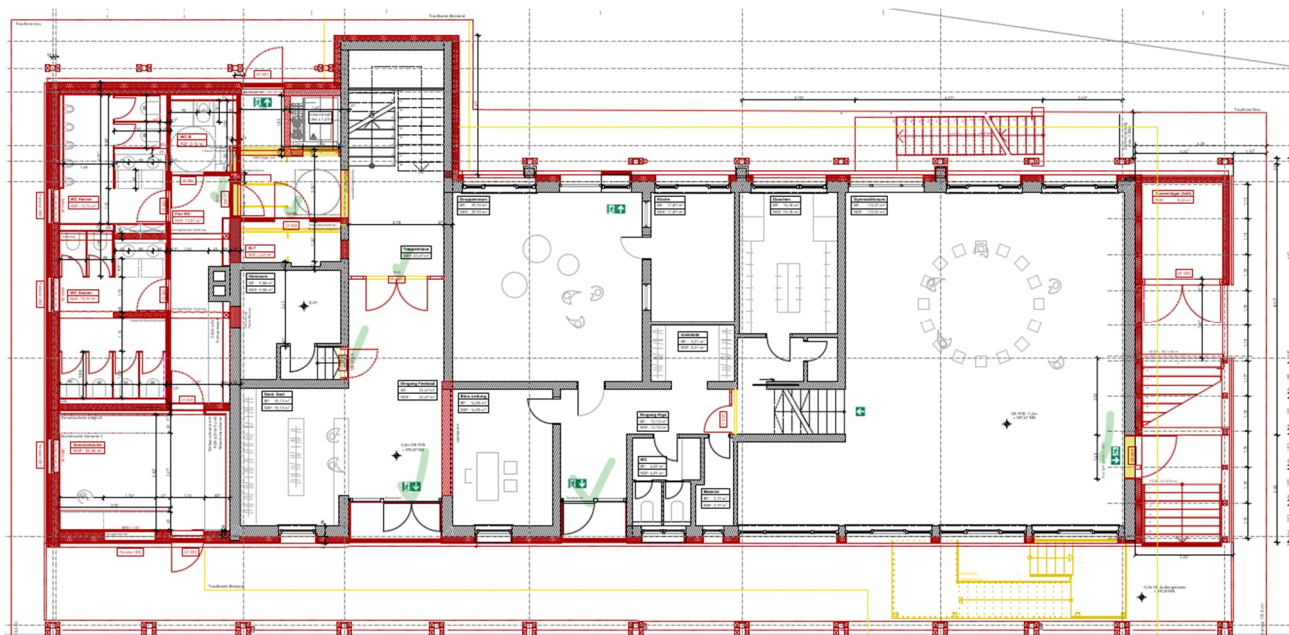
Übersicht Grundriss EG geplant
